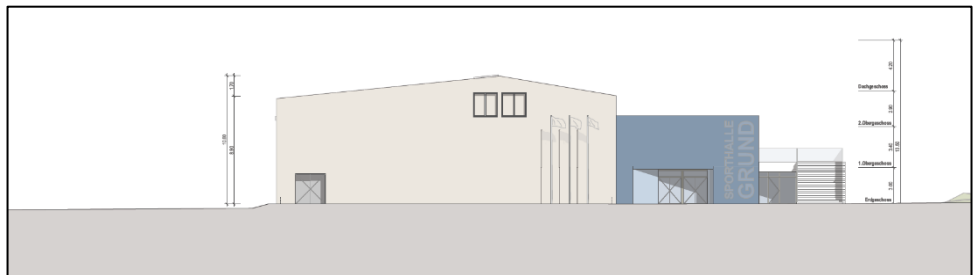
Westfassade Projektstudie Sporthalle Grund vom 11. Mai 2020, Gebau AG
